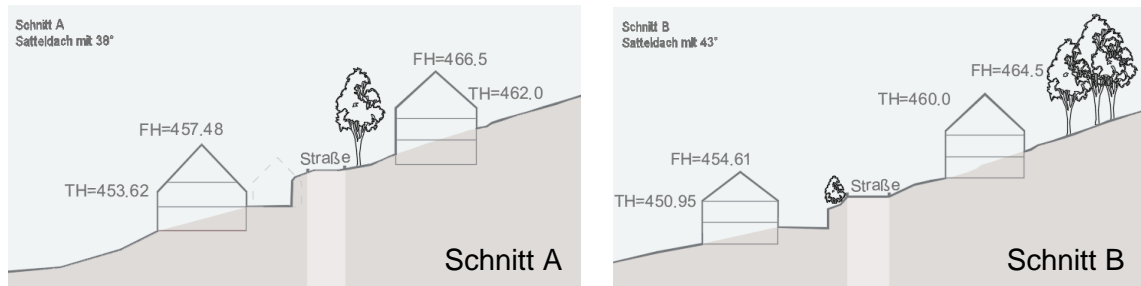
schematische Darstellung einer möglichen Bebauung im Schnitt mit Satteldach zusammen mit der bestehenden Bebauung (Quelle: eigene Darstellung)
